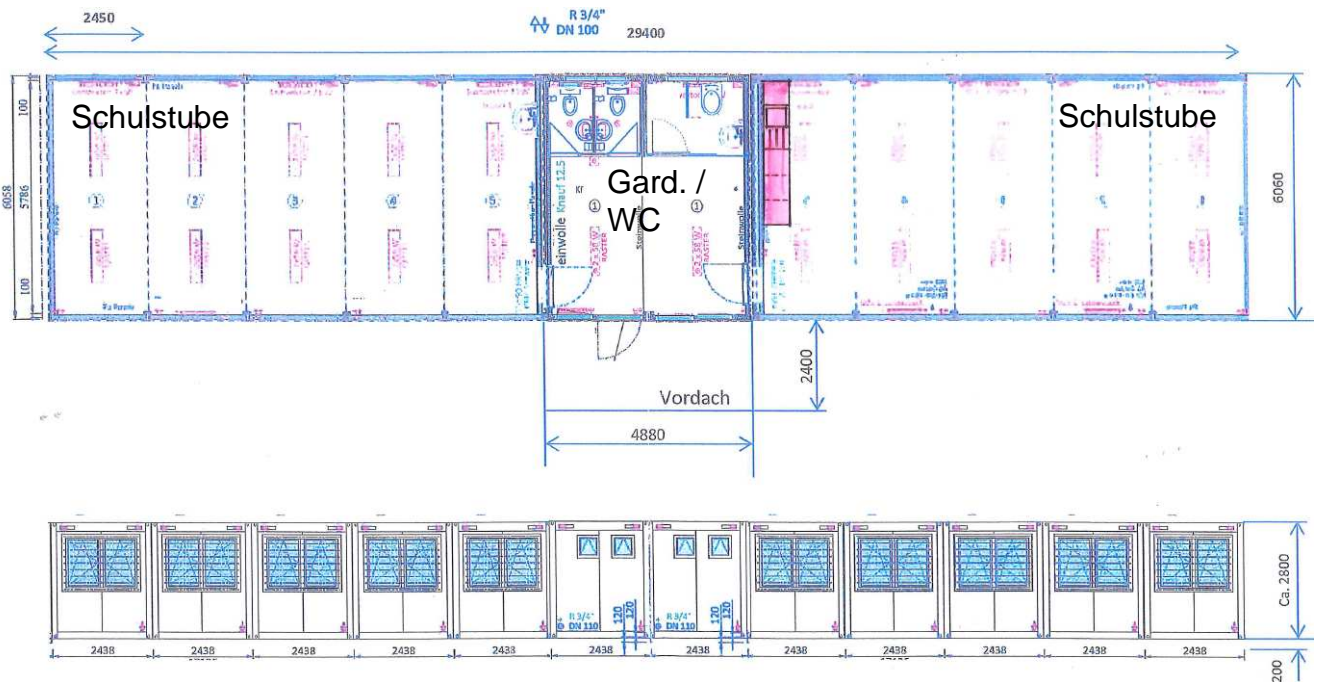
, Bestehendes Provisorium für Doppelkindergarten Bilander
